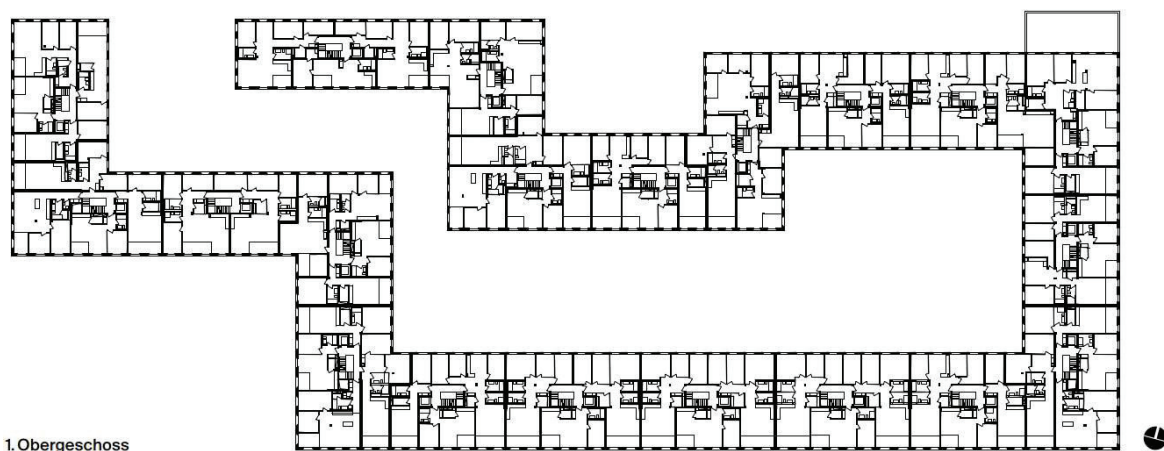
Grundriss der Überbauung Sue&Til, Grafik: Timbatec Holzbauingenieure
